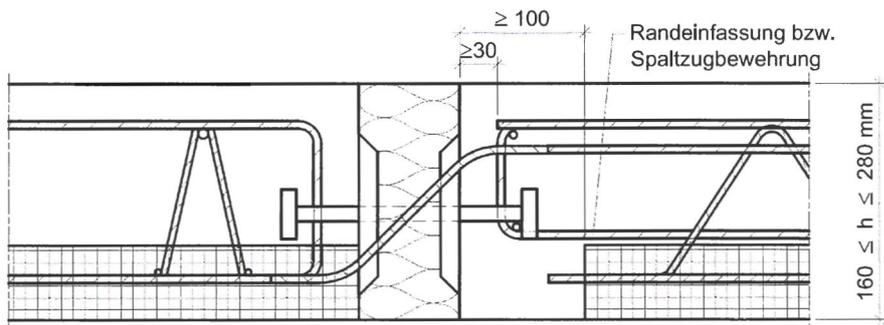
Beispiel Schöck Isokorb Typ Q mit Elementplatten
